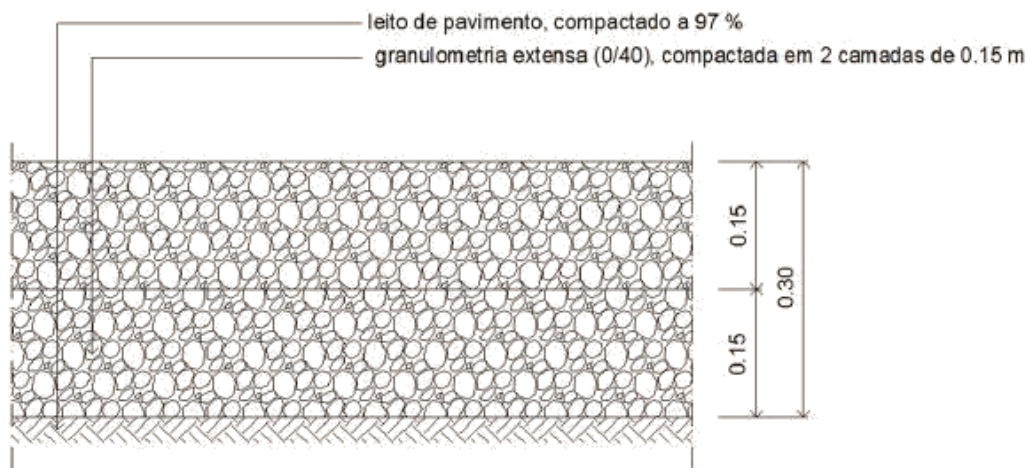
Corte tipo de pavimento granular usual em ABGE³⁷
